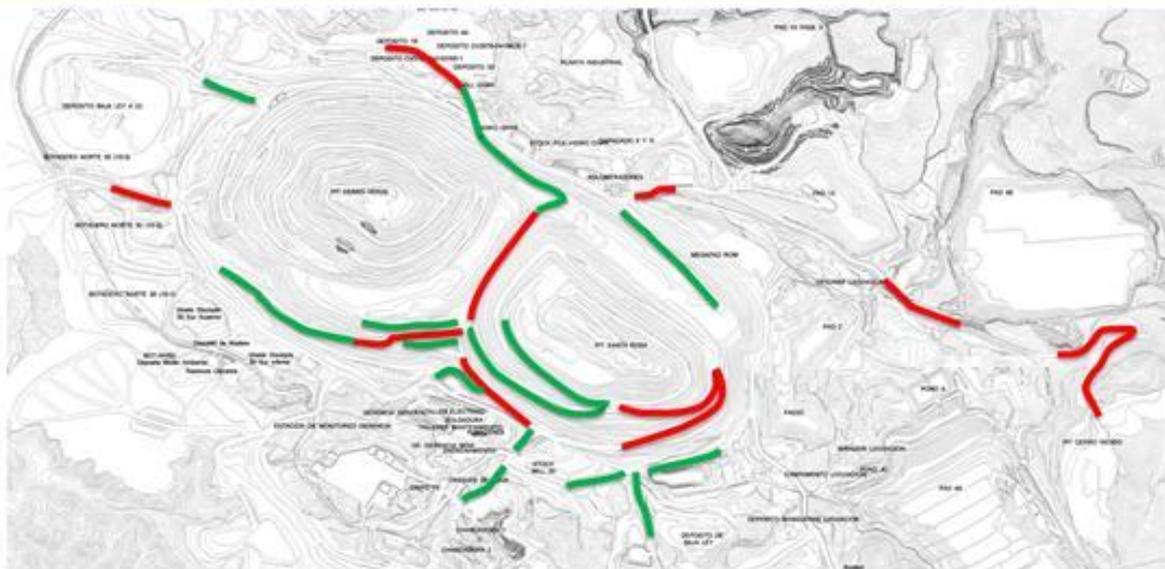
Avance y pendiente del plan de lastrado Fuente Cerro Verde
